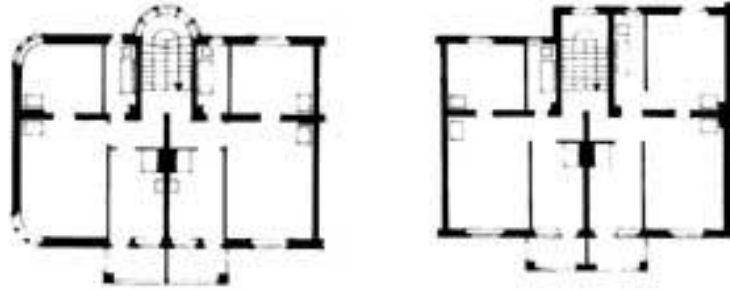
At nalı şeklindeki apartman bloklarının tipik kat planı [88], [89]
